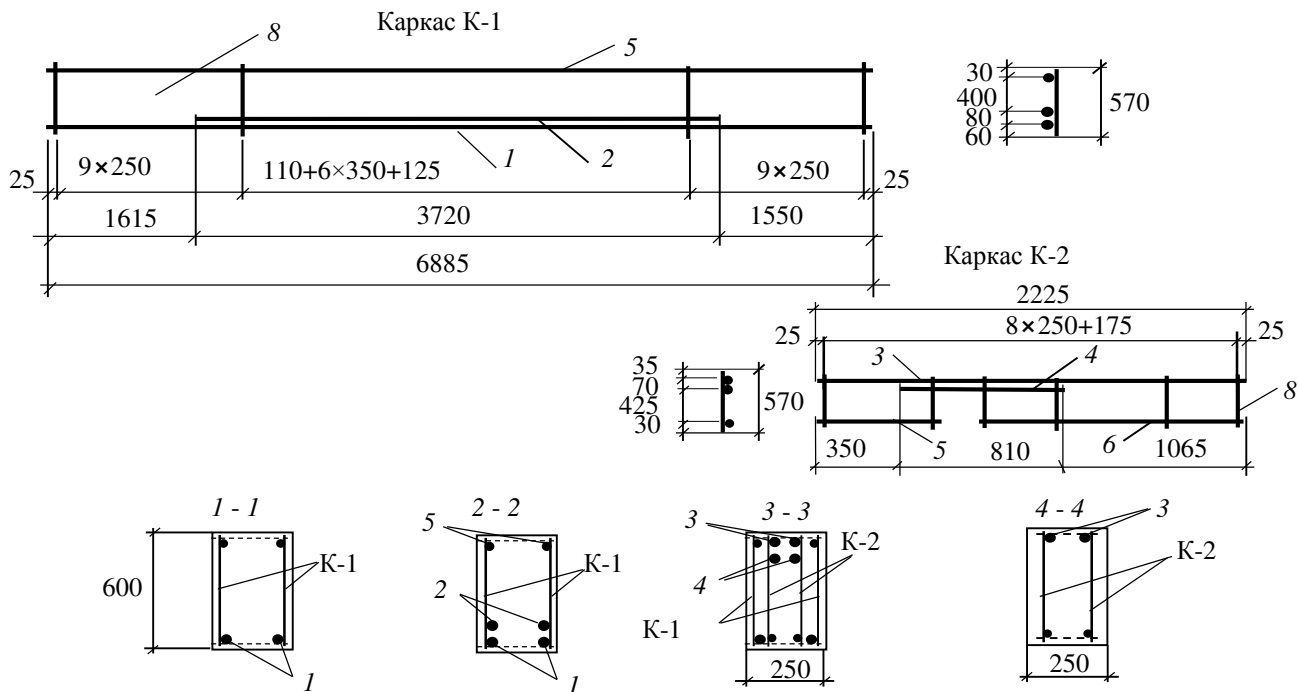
Схема армування залізобетонної однопролітної балки з консоллю
